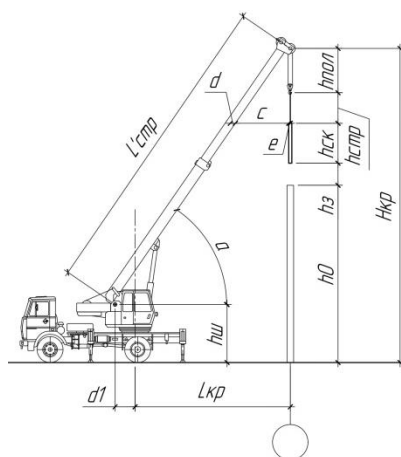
Визуальная схема для определения требуемых технических данных крана на монтаж фермы
